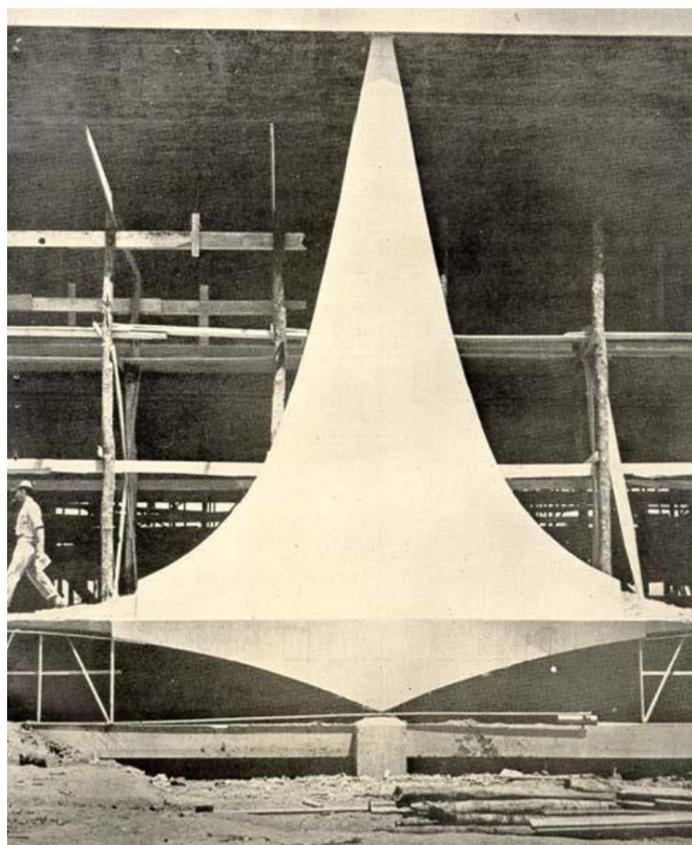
Detalhe da Construção de uma das colunas do Palácio da Alvorada. Foto reproduzido da Revista Brasília, janeiro de 1958.
